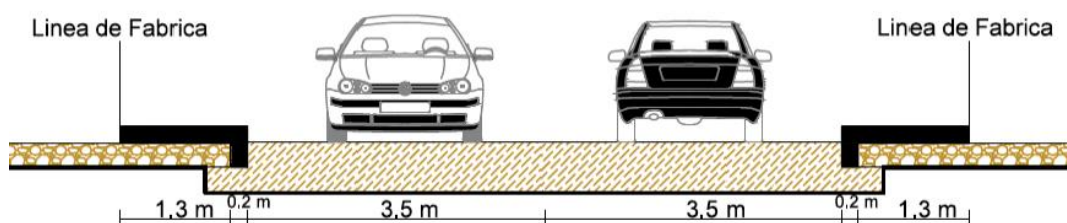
Sección transversal de la vía (Fuente: Elaboración propia)
